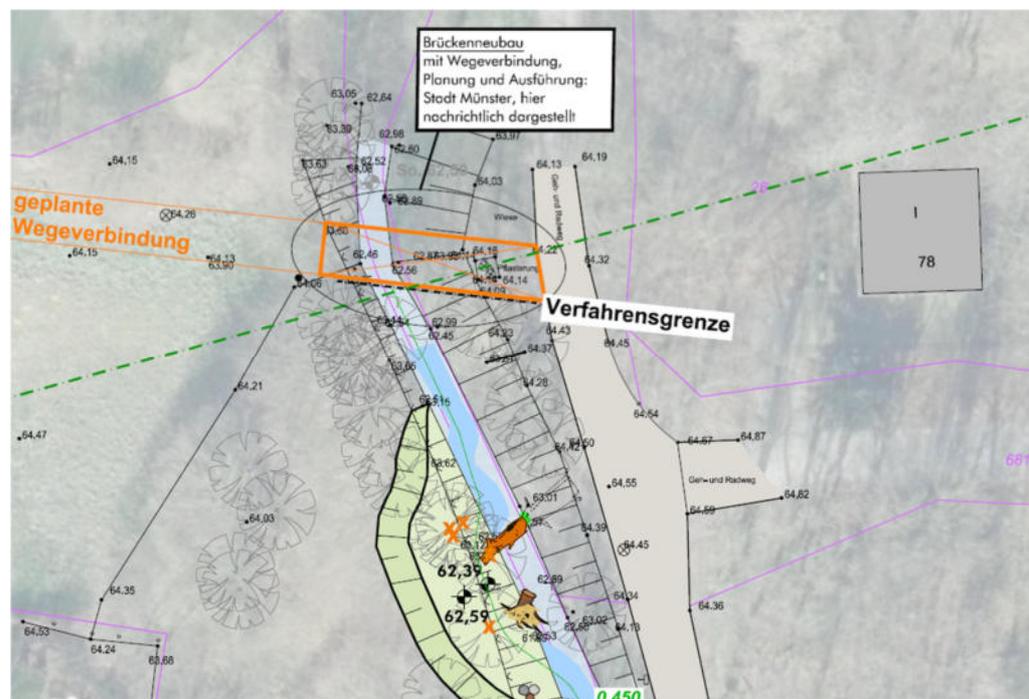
geplante Wegeverbindung mit Brücke (Planung / Ausführung Stadt Münster nachrichtlich)
